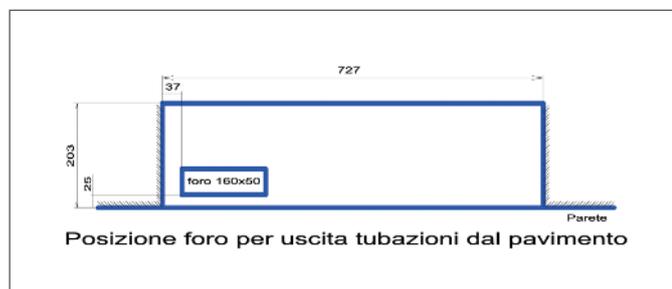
Posizione foro per uscita tubazioni dal pavimento
